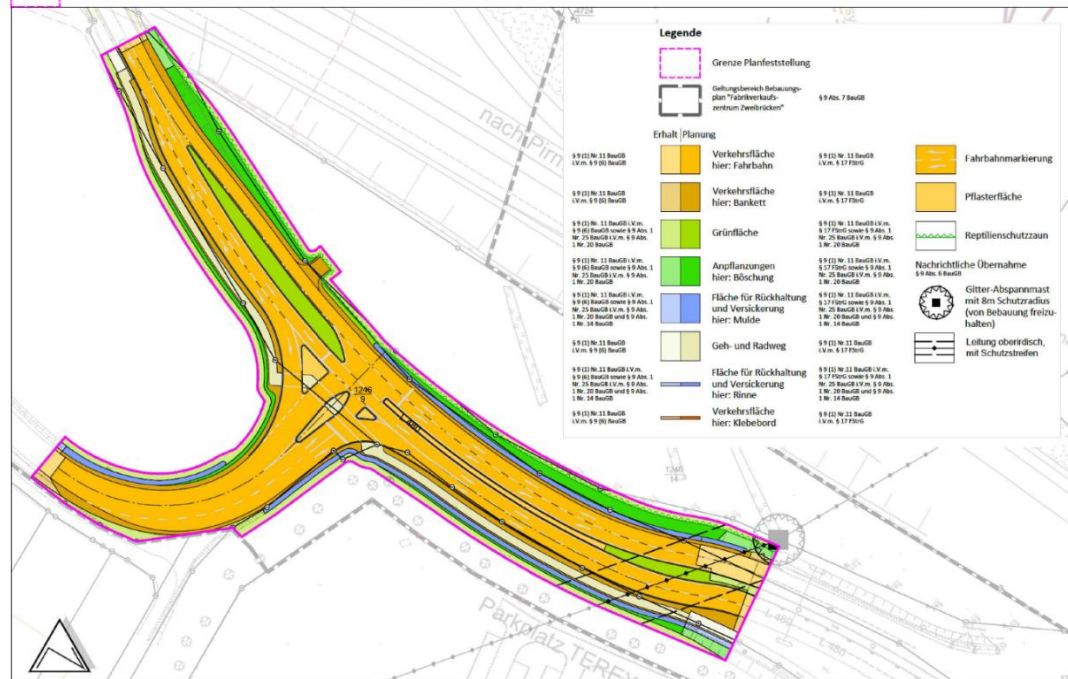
Zeichnerische Festsetzungen für den planfeststellungsersetzenden Teilbereich B „Knoten Süd“ unmaßstäblich, FIRU mbH auf Grundlage Schönhofen Ingenieure, 2025
